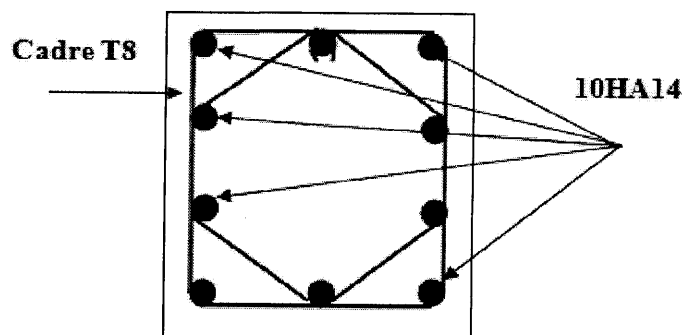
schéma de ferrailage des poteaux 45×40.
